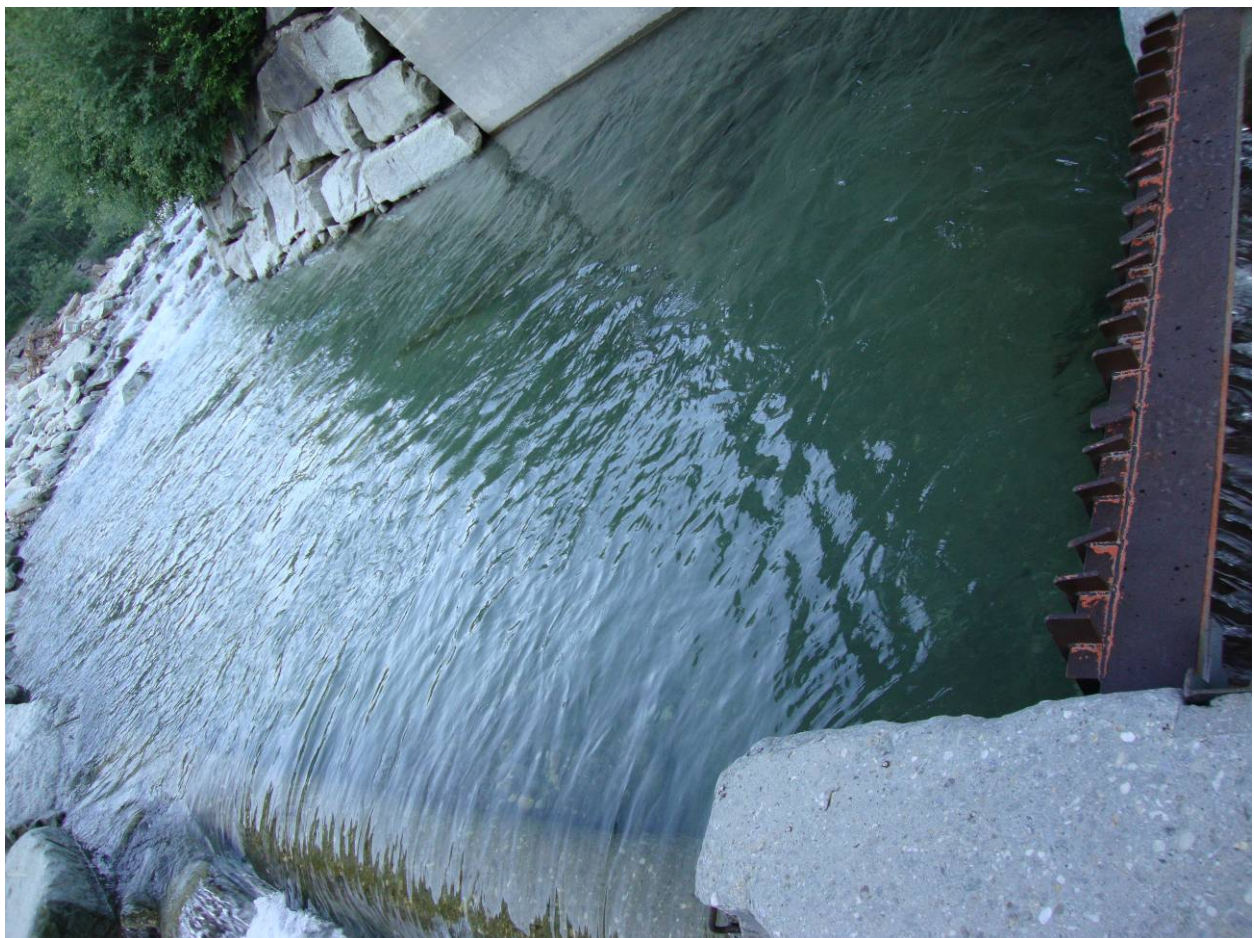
Einlauf Fassungsbauwerk mit Überlauf 1
